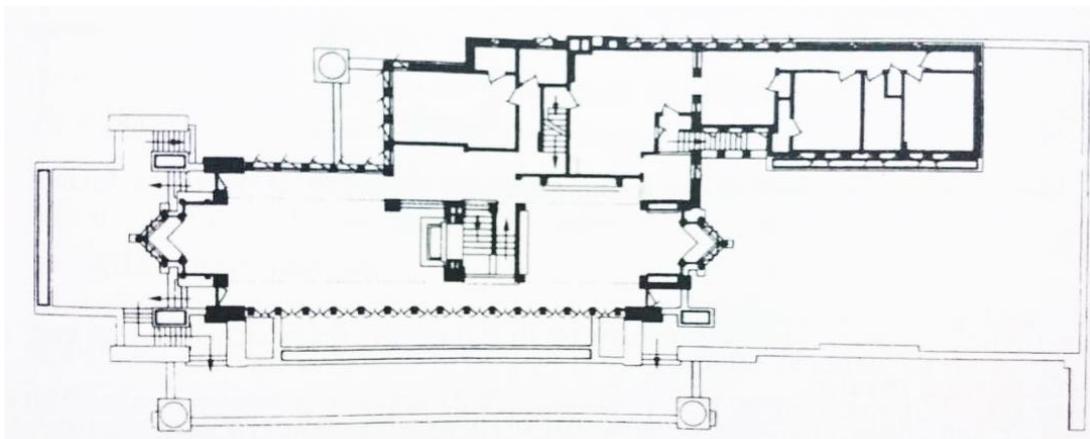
Wright, Casa Robie, 1908, Planta baixa do primeiro pavimento.
